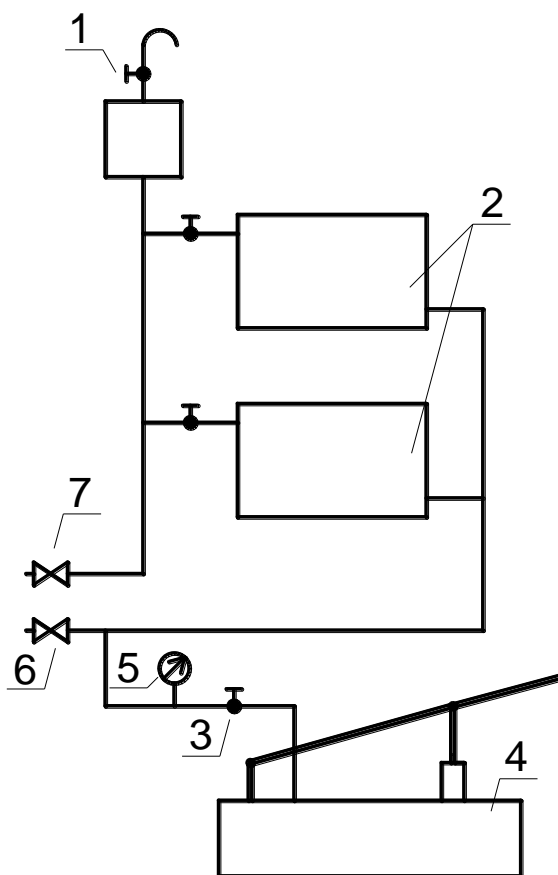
Схема гидравлической опрессовки системы отопления жилого здания
